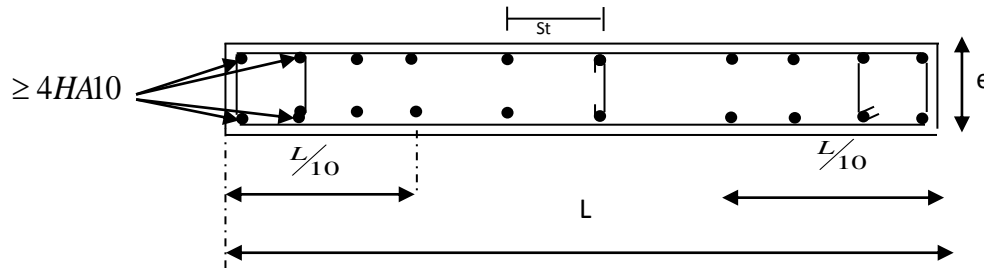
Disposition des armatures verticales dans les voiles.
